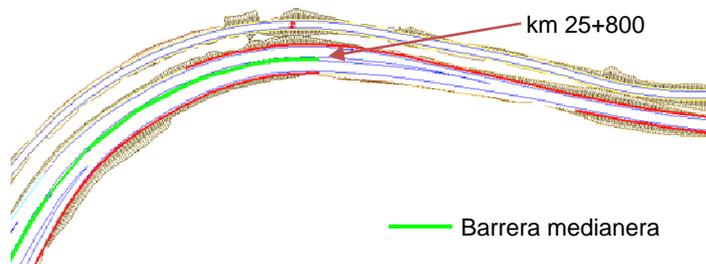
Vista en planta de barrera medianera colocada en Est. 25+800 (Sentido San José-Caldera).
